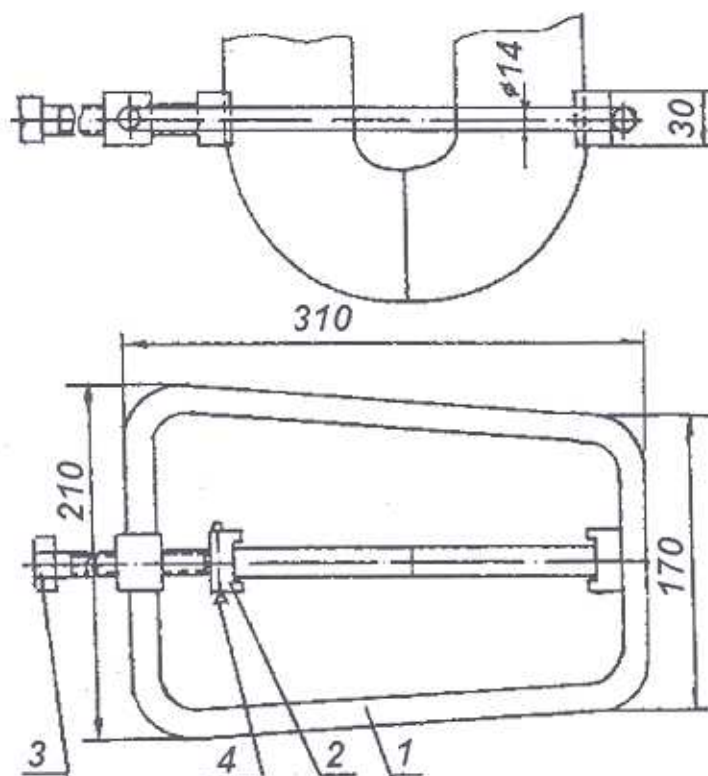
Приспособление для соединения головок стержней при пайке:
